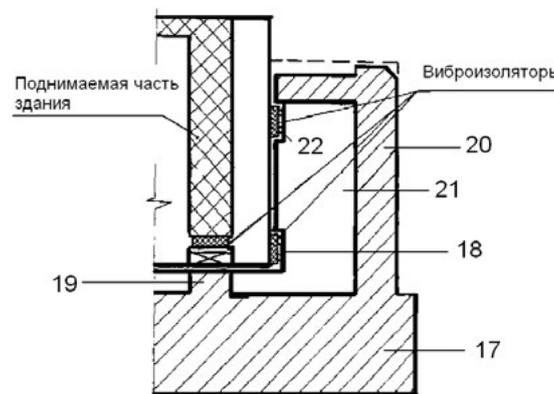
Схема виброизоляции цокольного этажа в основании здания
